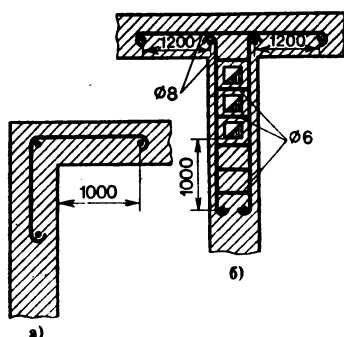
Армирование угла (а) и примыкания внутренней стены к наружной в местах прохождения каналов (б)
